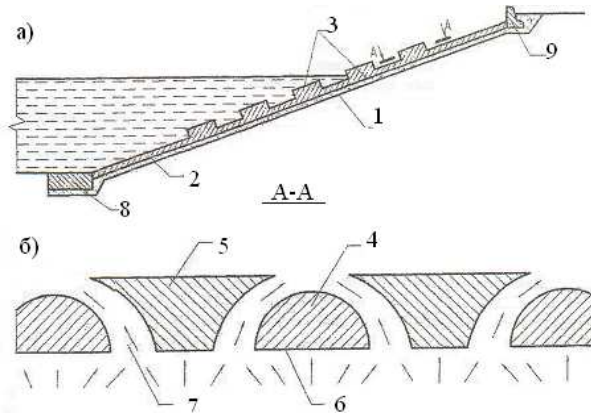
Схемы элементов поперечных сечений в срединных частях прудовых плотин на балках
